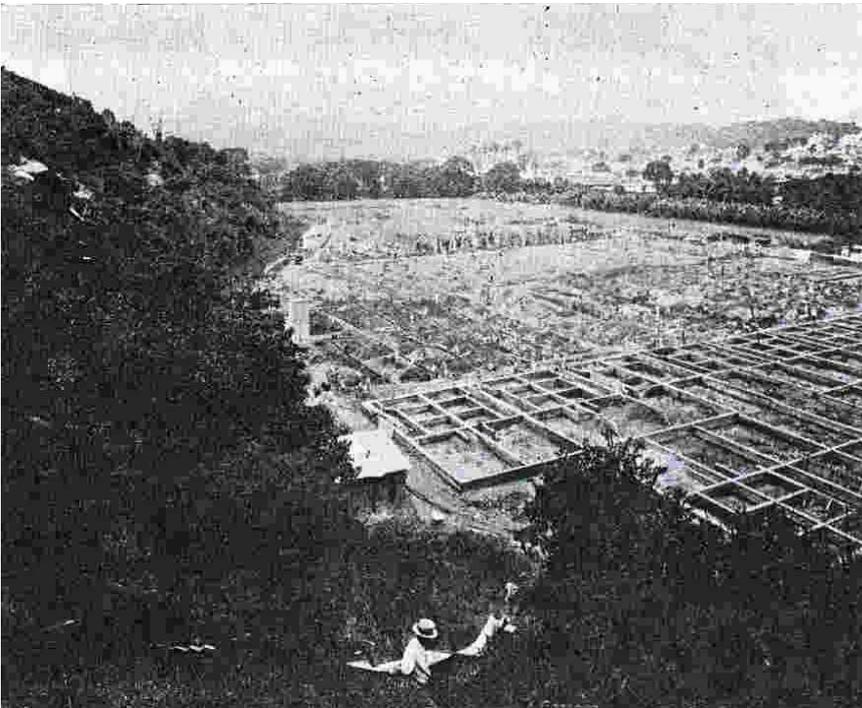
La construcción de la Urb. San Agustín del Sur.
